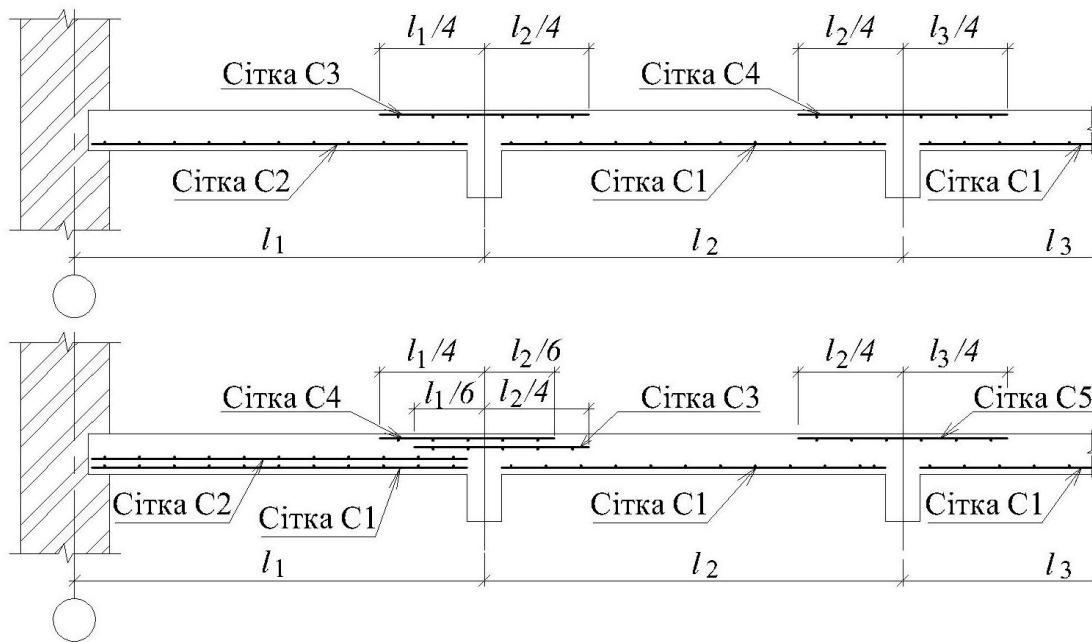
Армування плит зварними сітками з поперечною робочою арматурою (варіанти)
